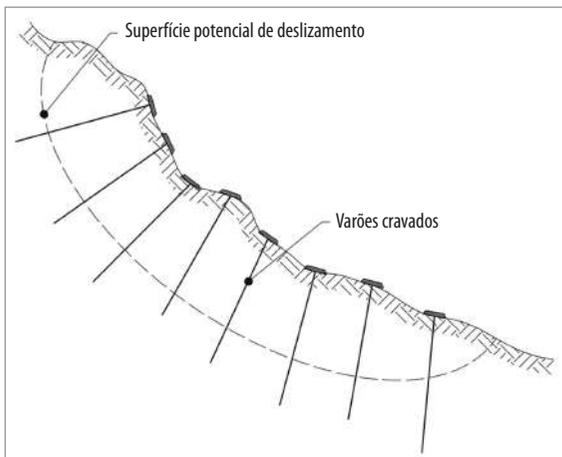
Estabilização de um talude natural com pregagens cravadas no terreno
